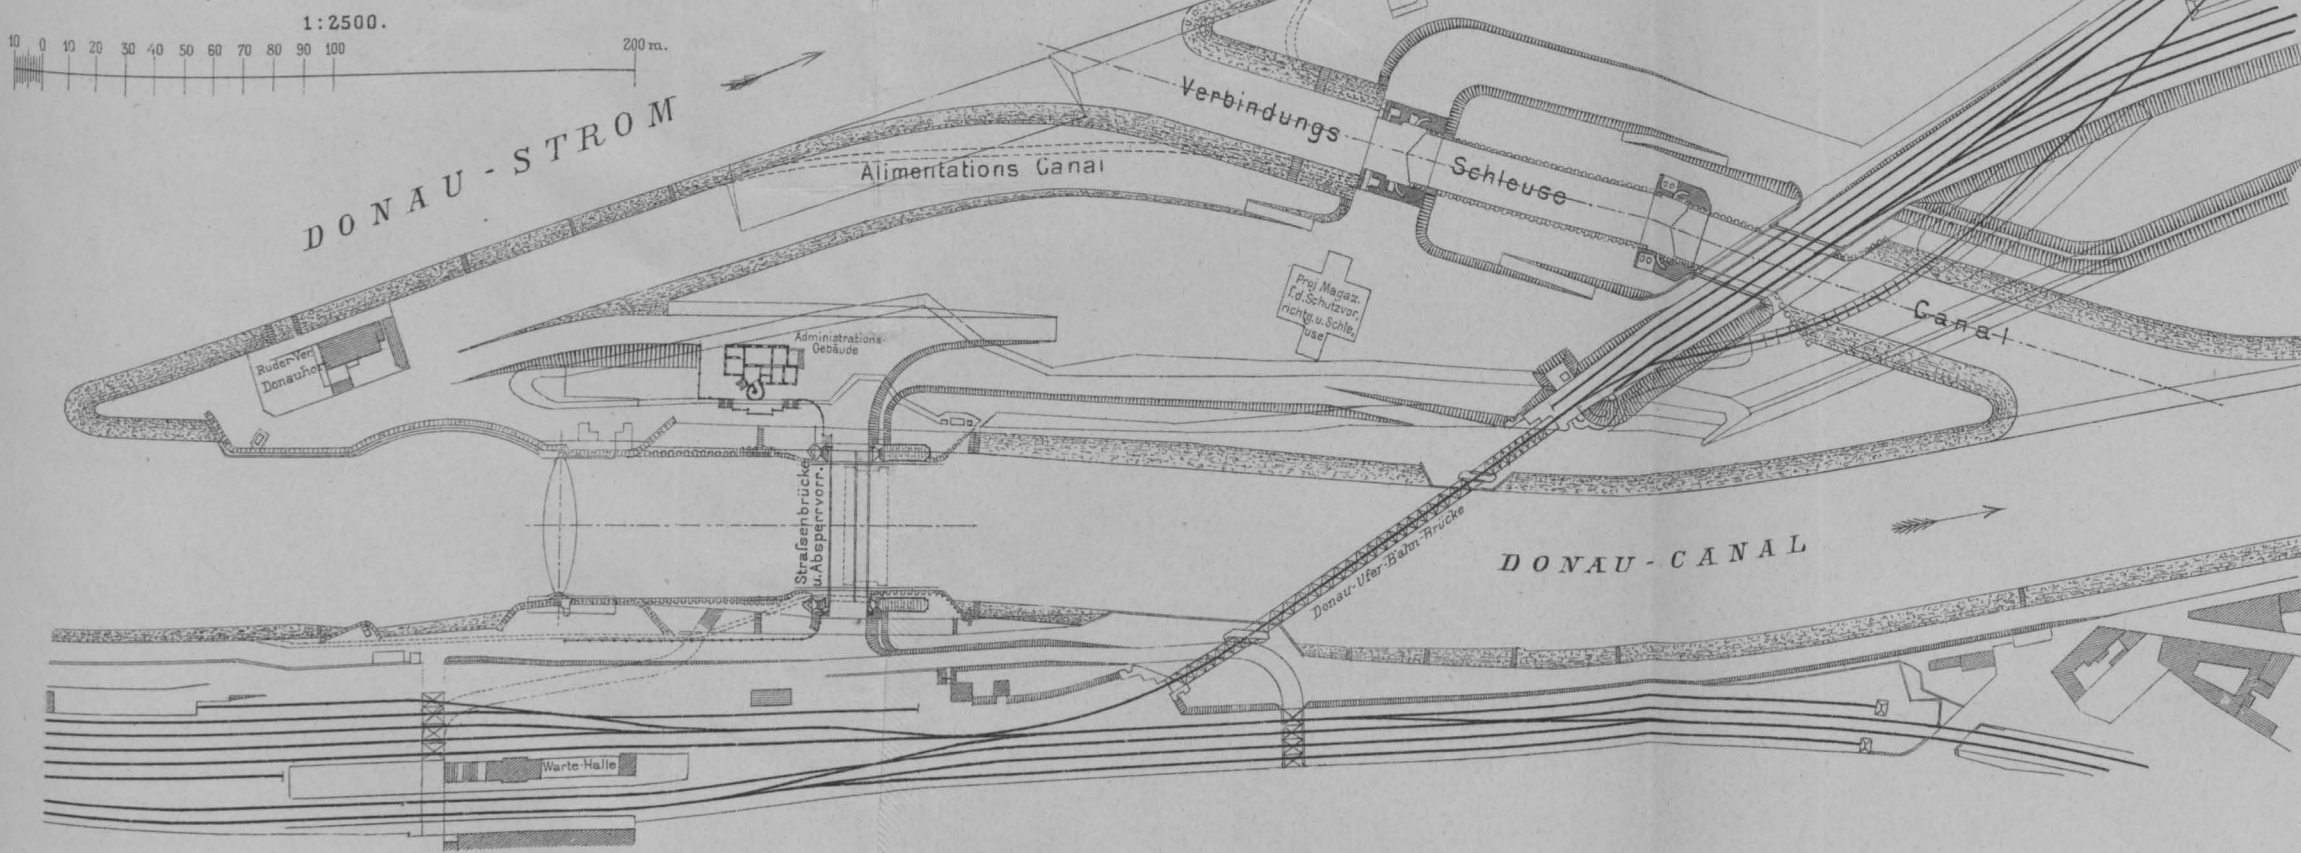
Grundriss der Absperrvorrichtung.
